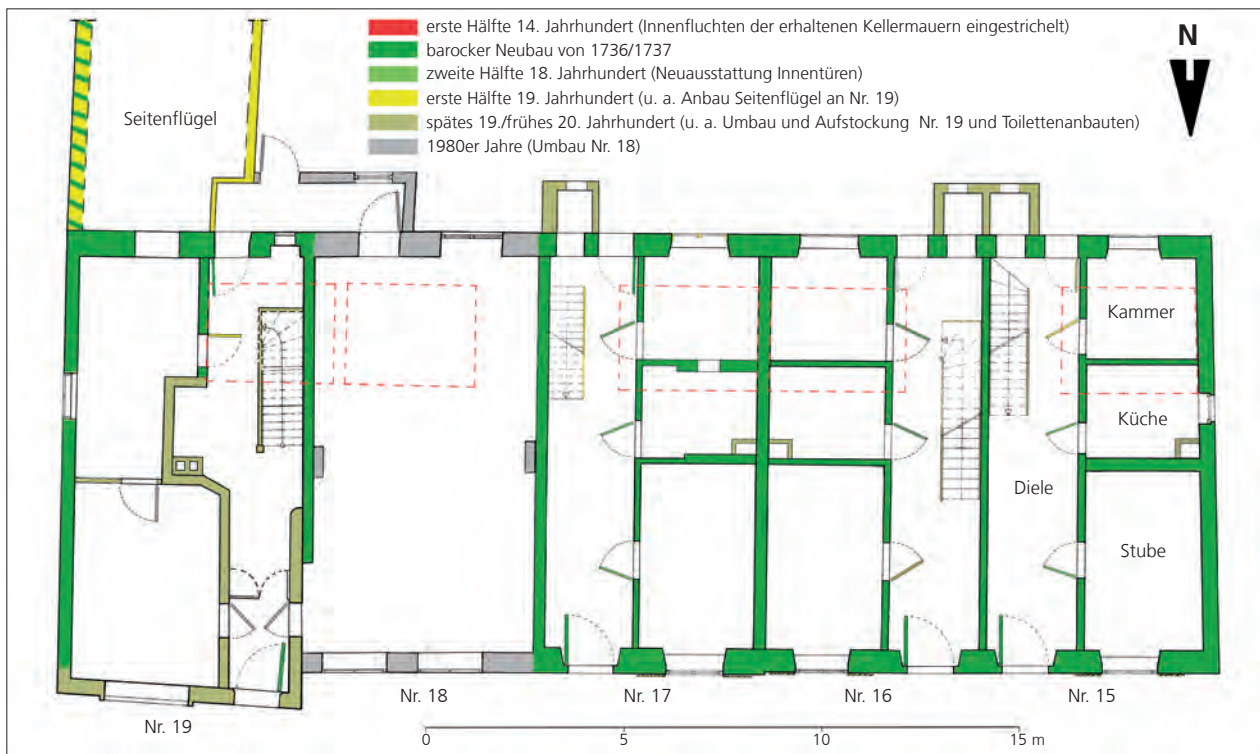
Greifswald, Domstraße 15-19. Baualtersplan der Hauszeile. Zustand vor den Umbauten der 1990er Jahre. Zeichnung: T. Rütz (1213). Plangrundlage: Architekturbüro Harm und Partner (1993) sowie Tangram Planwerkstatt (2005)
